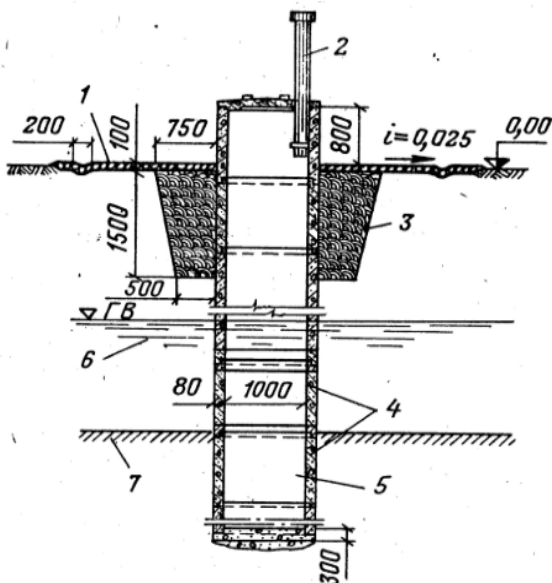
Шахтный колодец: 1 – отстойка; 2 – вентиляционная труба; 3 – глиняный замок; 4 – железобетонные кольца ( в зоне приема воды с вставками из пористого бетона); 5 – отстойник; 6 – водоносный горизонт; 7 – водоупор
